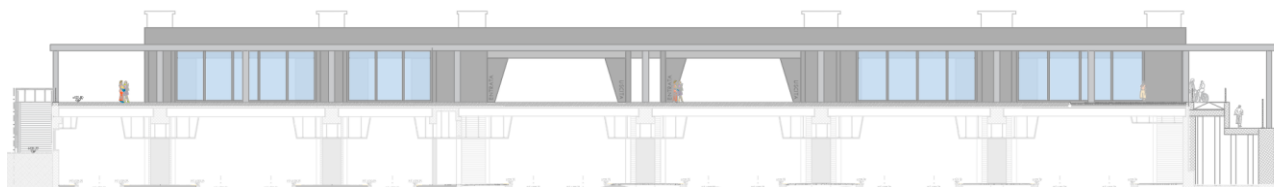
Sezione trasversale in corrispondenza del piazzale lato Milano – prospetto sud.
